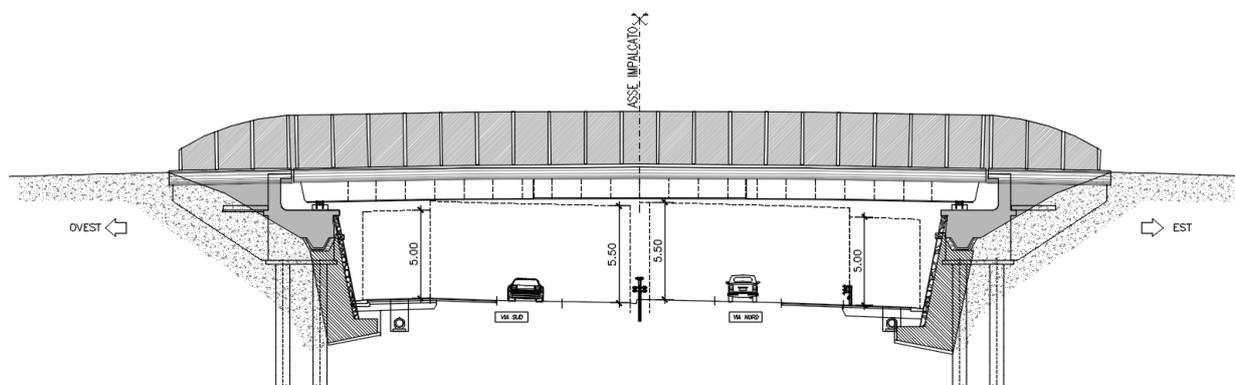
Sezione longitudinale del nuovo sovrappasso n. 69
